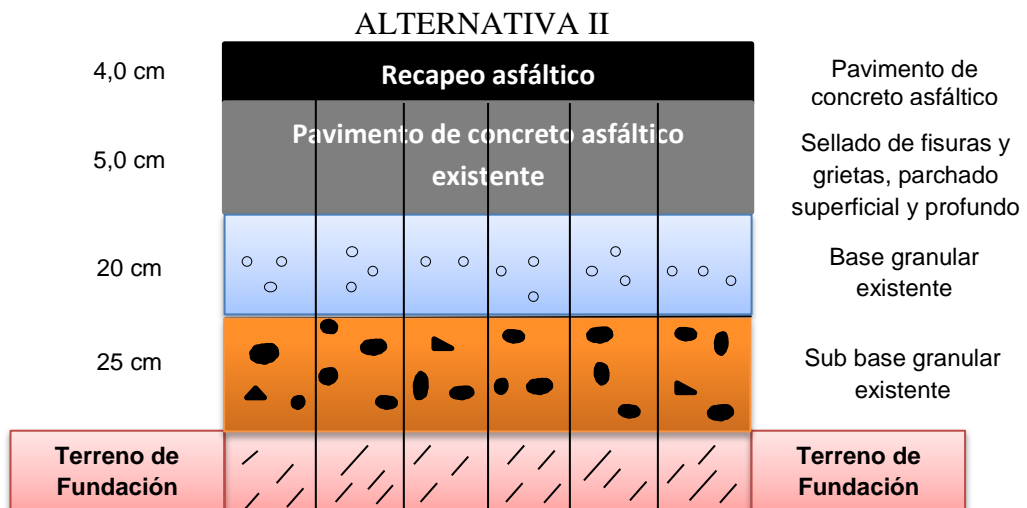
Solución alternativa II del sub tramo II. Sección estructural del pavimento, sellado de fisuras y grietas, parchado superficial y profundo en calzada y colocación de un recapeo asfáltico (pavimento de concreto asfáltico de  $e=1,5$ " )
